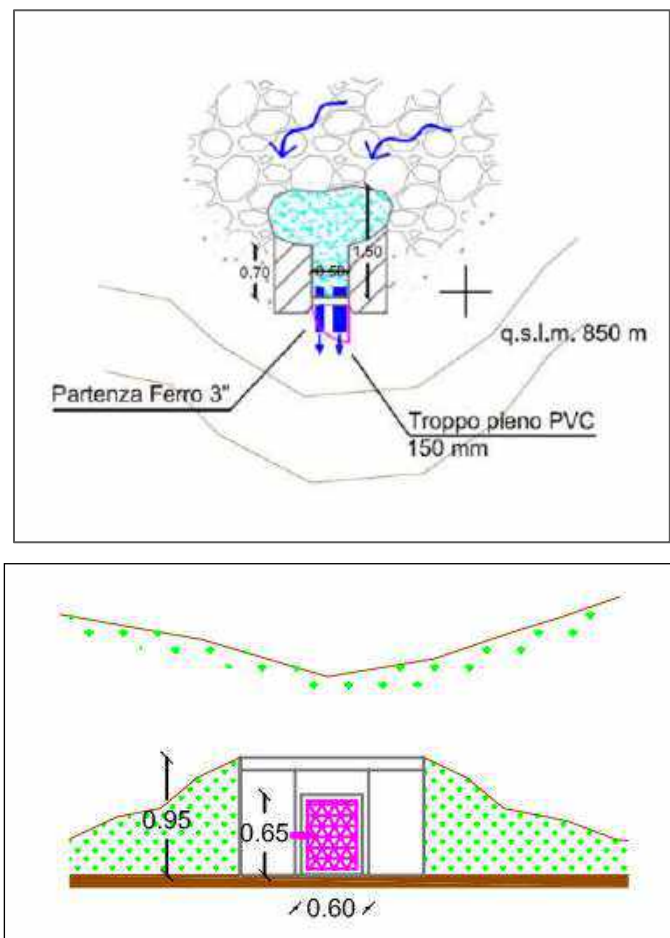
Pianta e prospetto Sorgente 1 Le Mesore
